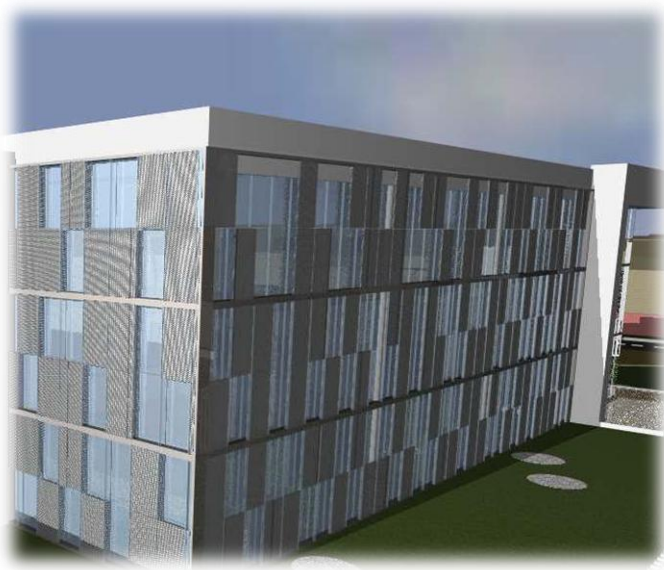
IMAGEN DE LA APLICACIÓN DE CRISTAL COLOR BLANCO Y EL METAL EN LAS FACHADAS.
